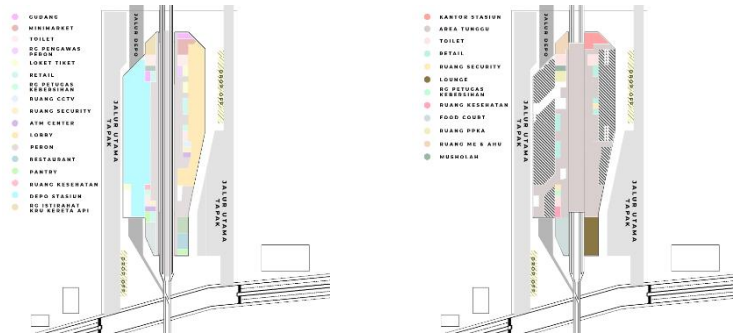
Konsep Gubahan Massa Bangunan, dari kiri ke kanan : Perletakan Relatif Massa Bangunan, Rancangan Konfigurasi Geometrik Massa Bangunan
